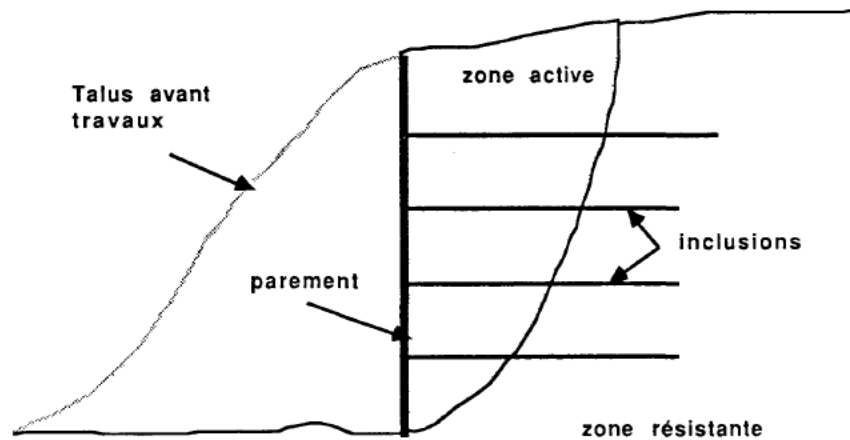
Stabilisation d'une Excavation (pente artificielles)[17].
